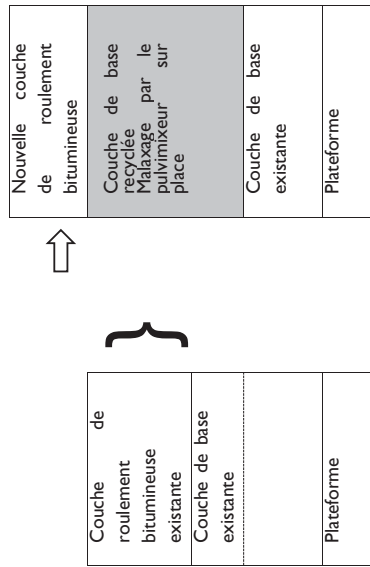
Exemple de travaux de stabilisation du revêtement existant
